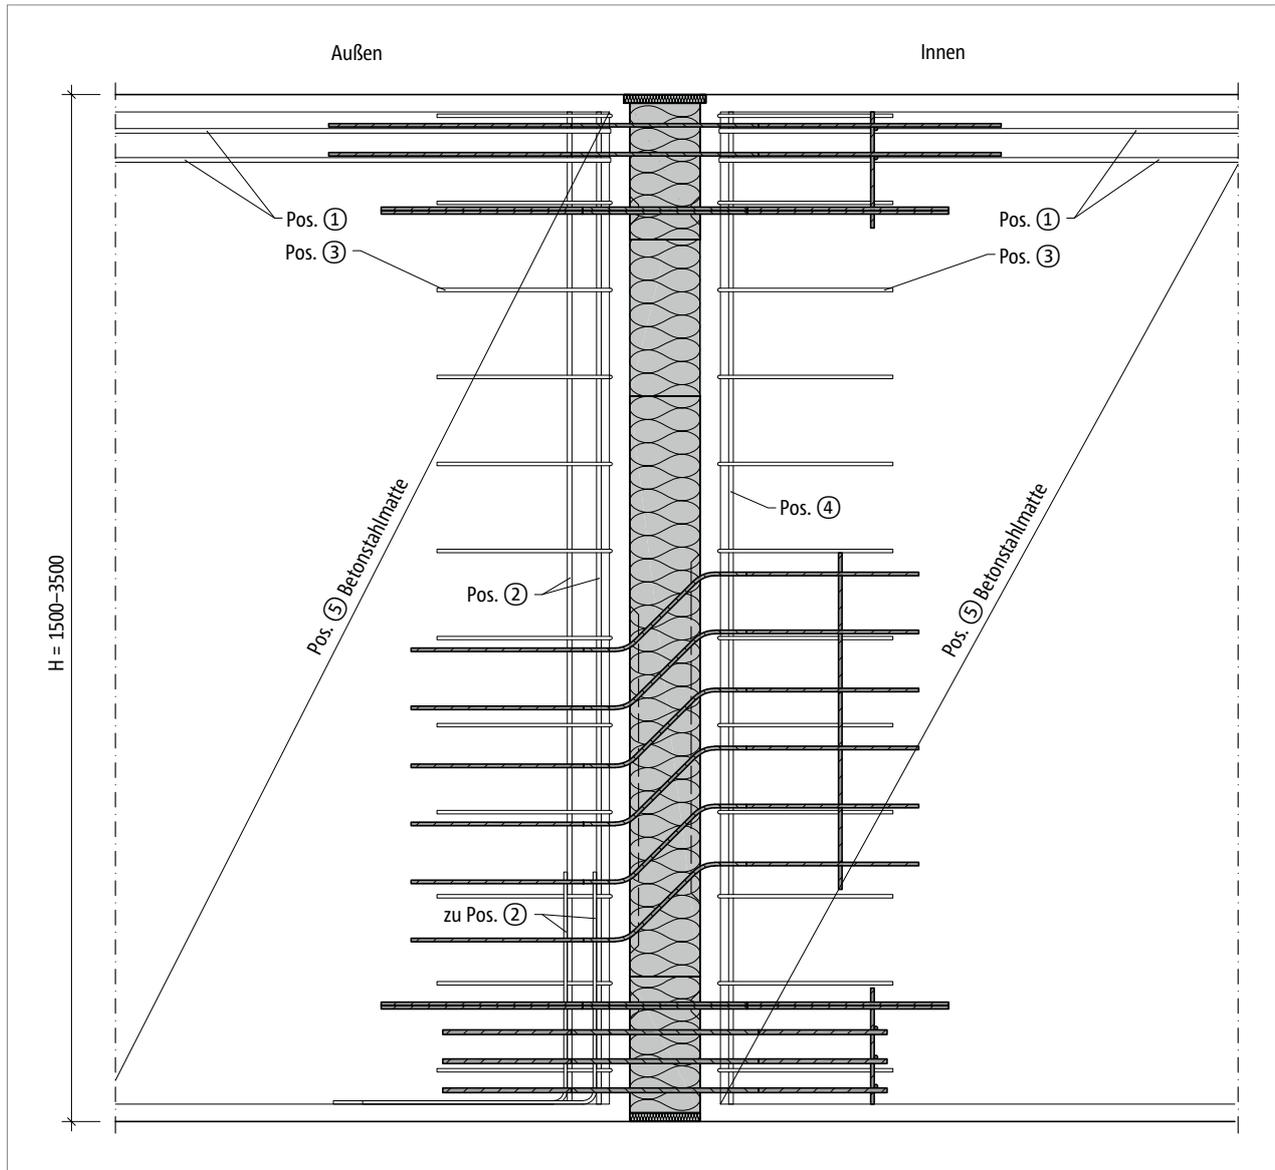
Schöck Isokorb® XT Typ W: Bauseitige Bewehrung; Schnitt
